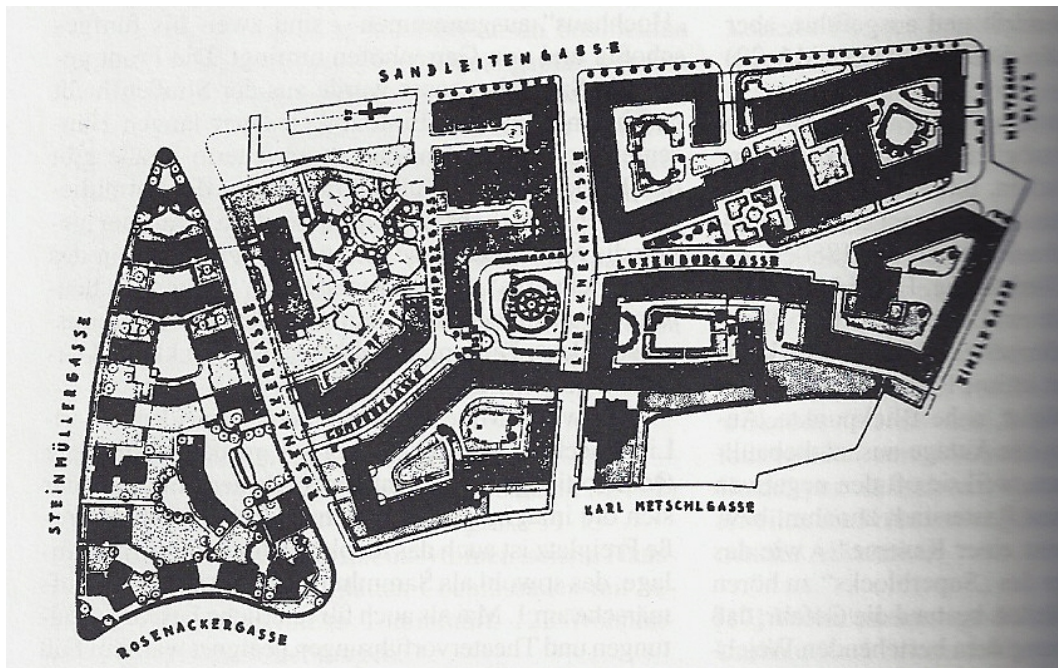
Lageplan Sandleiten-Hof, 1924-1928, 1160 Wien.
